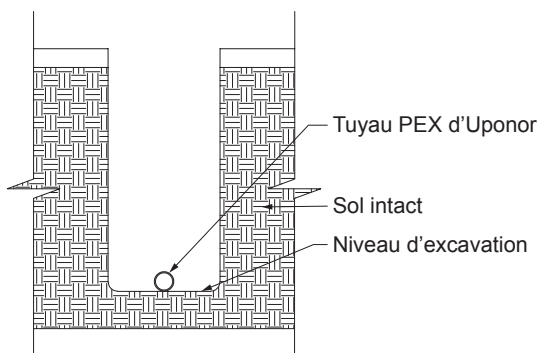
Condition du sol favorable — Si l'excavation de la tranchée se fait sans problème, installer la tuyauterie directement sur le fond préparé. Le fond doit être plat, sans trous, bosses ou cailloux.
